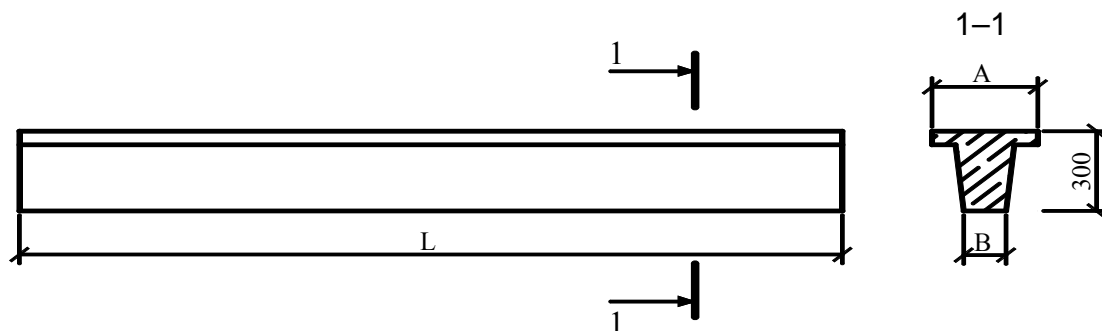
Фундаментные балки для стен из кирпича 510 мм. Блоки из легкого бетона толщиной 500 мм
